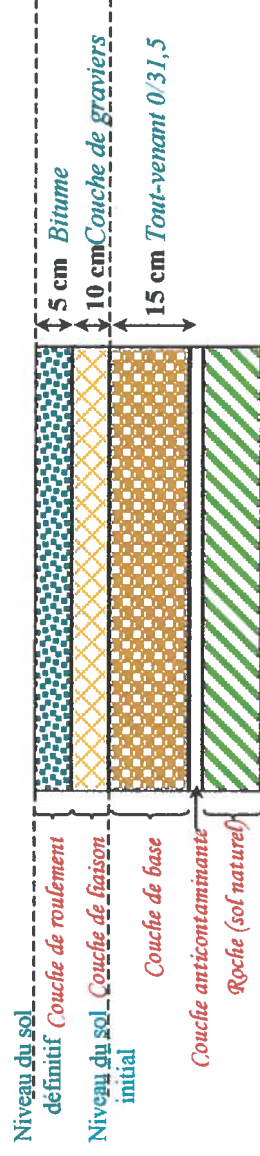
Coupe technique de la structure du revêtement sur le parking.
